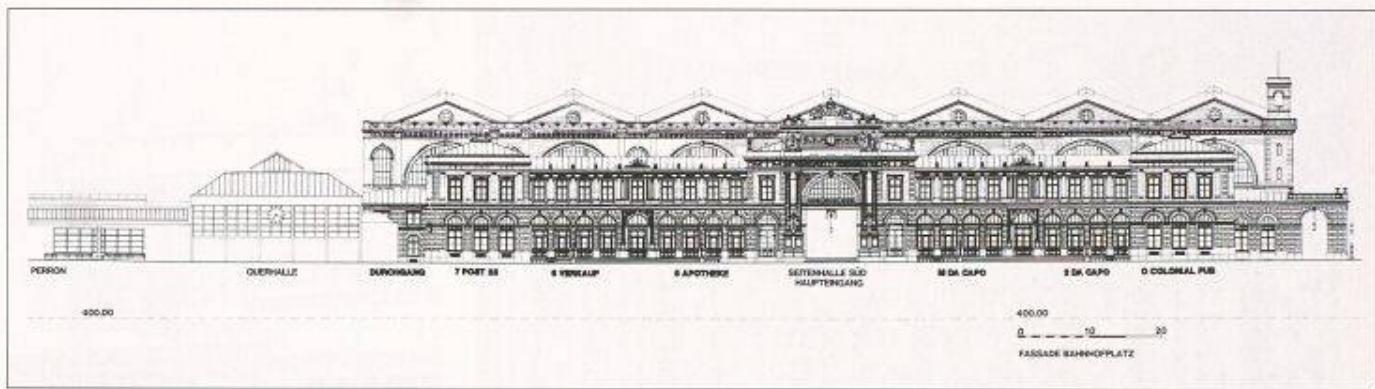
Projektplan 1992 (Fassade Bahnhofplatz). Wiederherstellung der Fassadengliederung.
